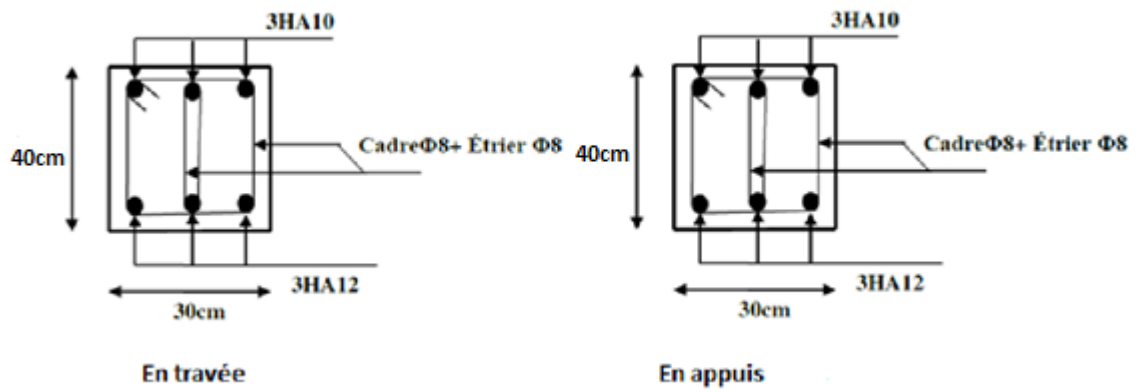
Schéma de ferrailage de la poutre de chaînage
